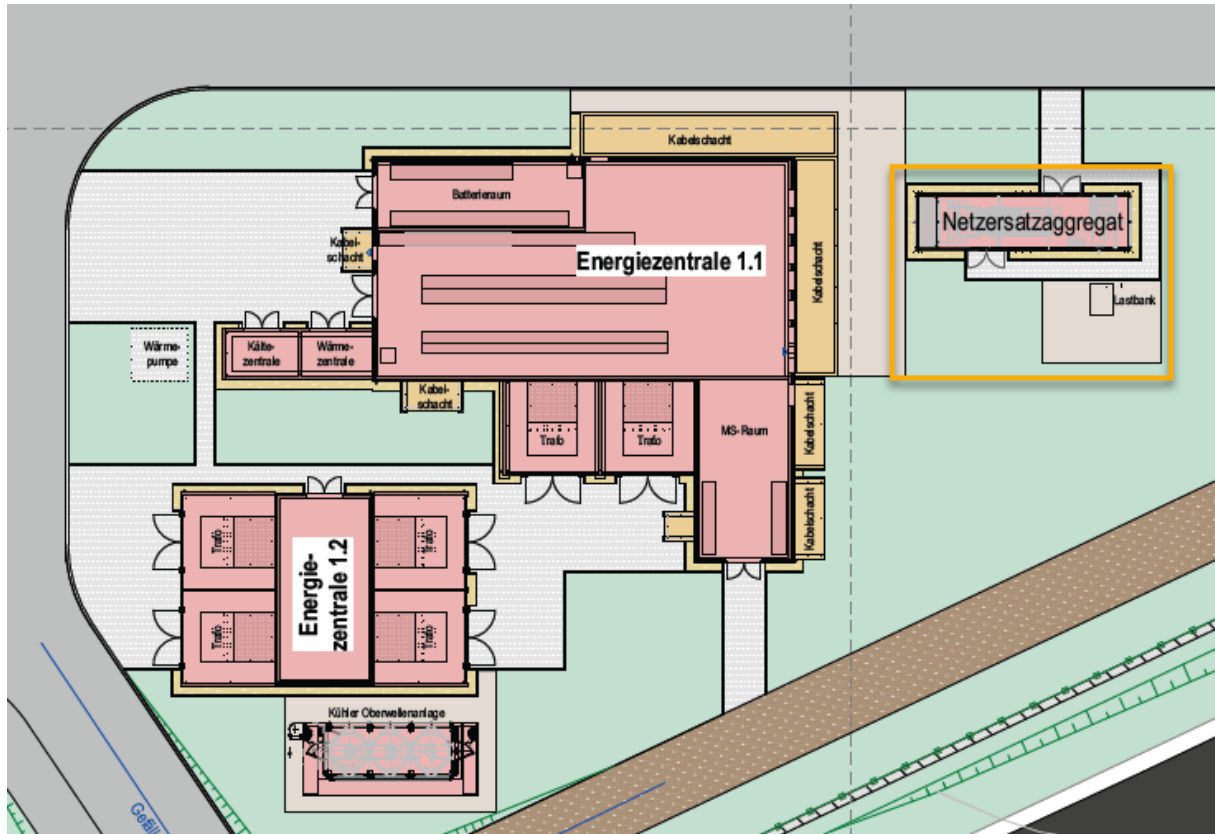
Ausschnitt aus dem Freiflächenplan – Netzersatzanlage (gelb umrandet)
